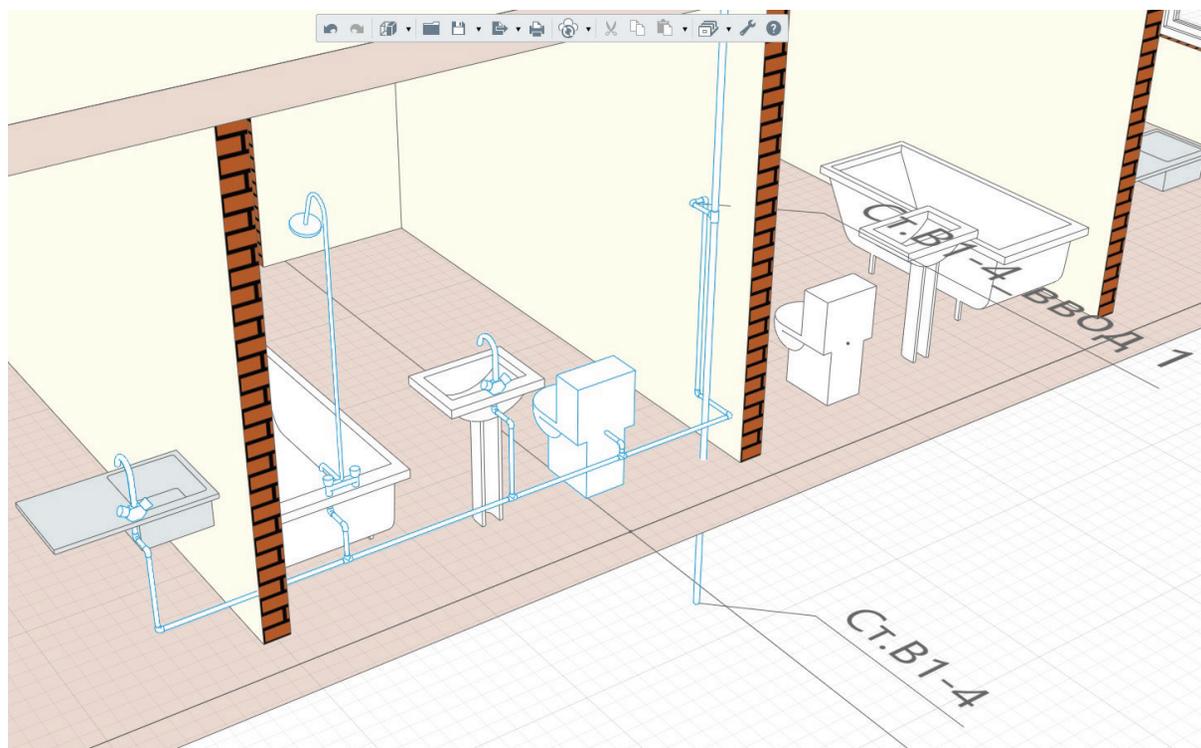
Поквартирная разводка водопровода на 3D-сцене
